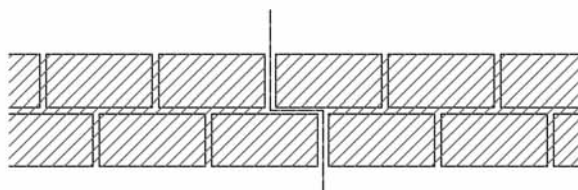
JUNTA DE MOVIMIENTO CON SOLAPE. ESQUEMA EN PLANTA
